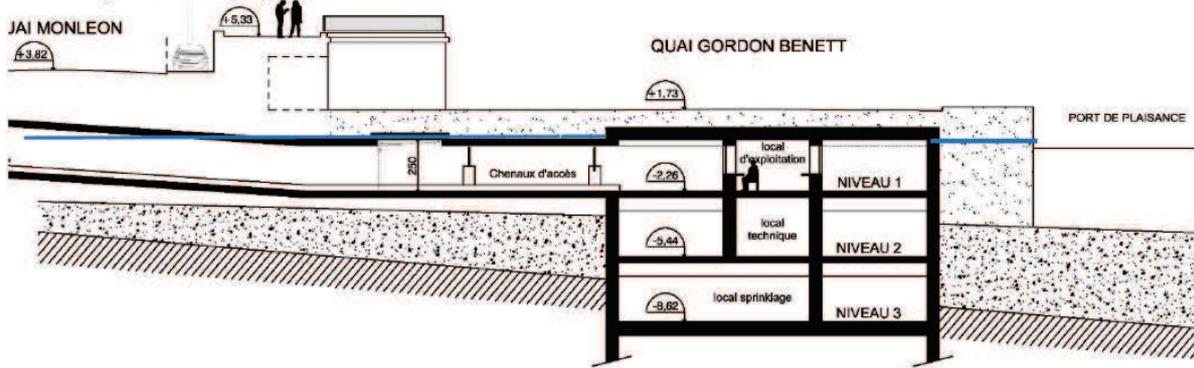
Coupe type en travers : coupe passant par le Vieux-Port
